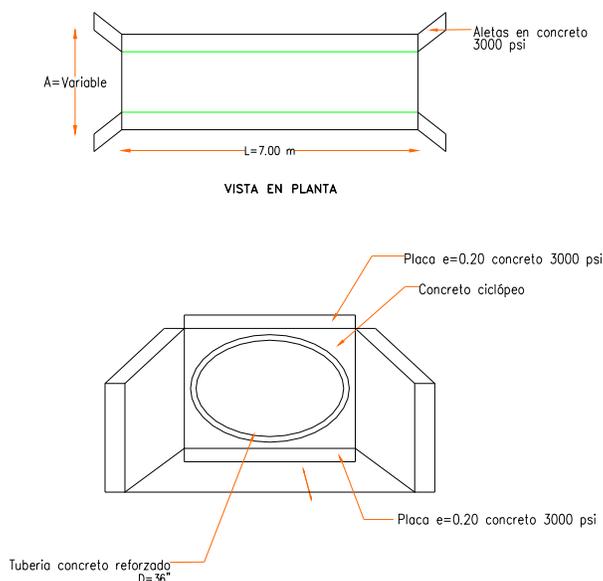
Sección típica de alcantarilla sencilla para manejo de aguas lluvias, se observa alcantarilla sencilla pero para la zona se plantean alcantarillas dobles de 36 pulgadas.
